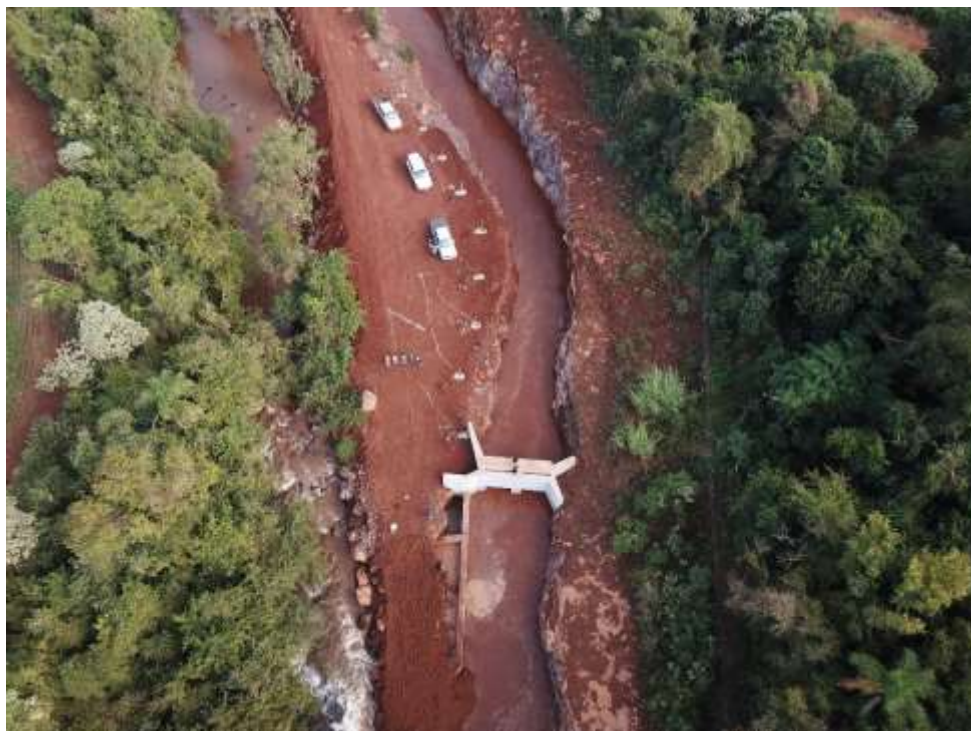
Foto aérea do canal após 1 hora da abertura da ensecadeira.
